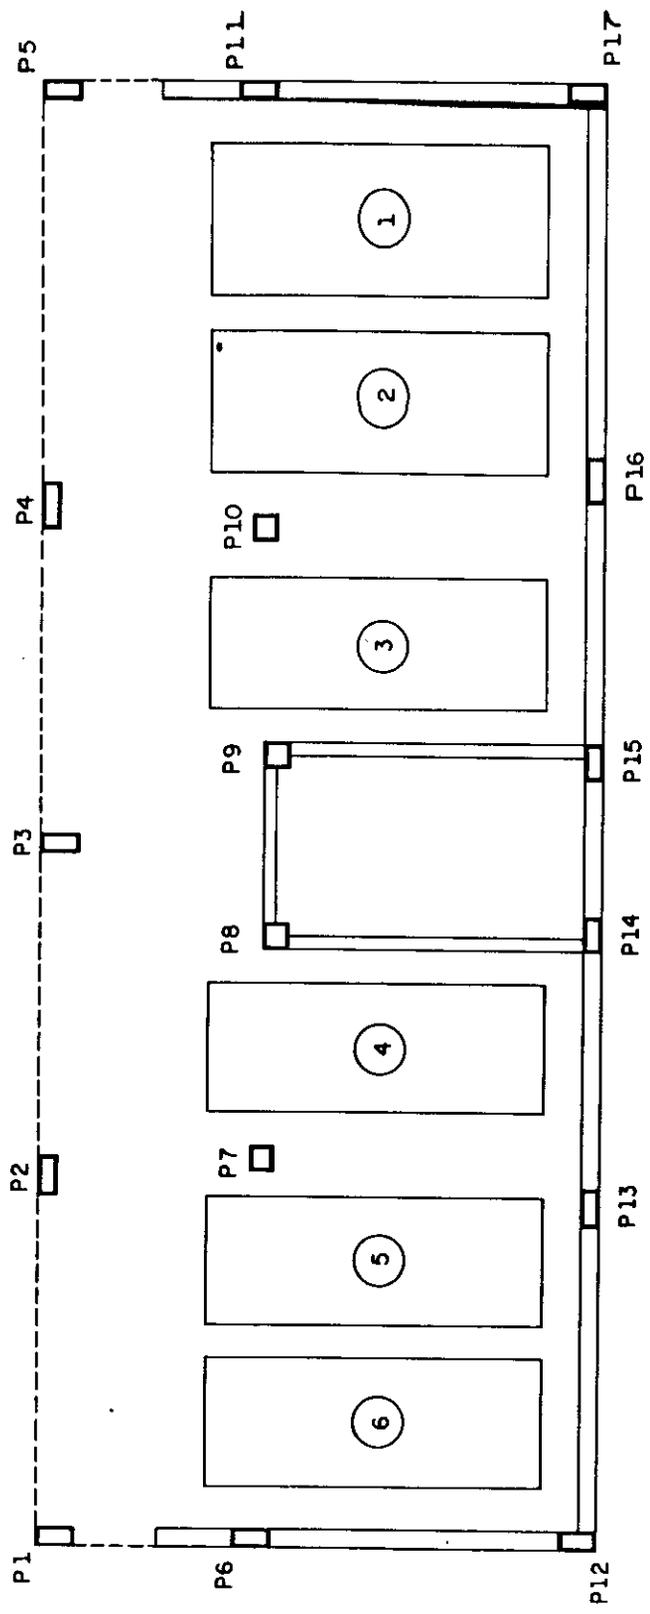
a - Estrutura I - Pavimento Tipo
